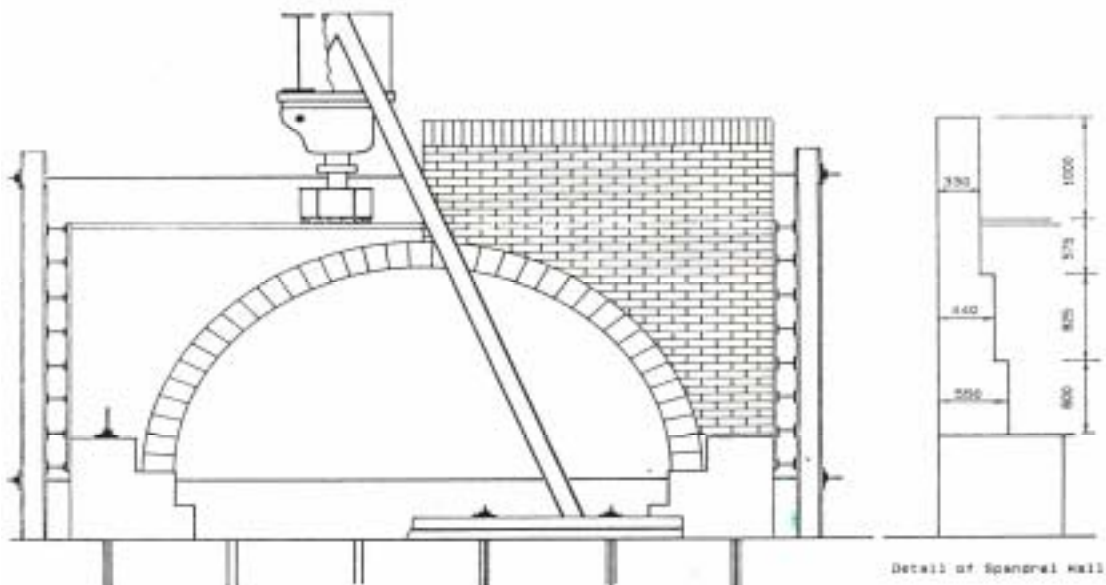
Alzado y detalle del tímpano del puente ensayado en la Universidad de Dundee [15].
